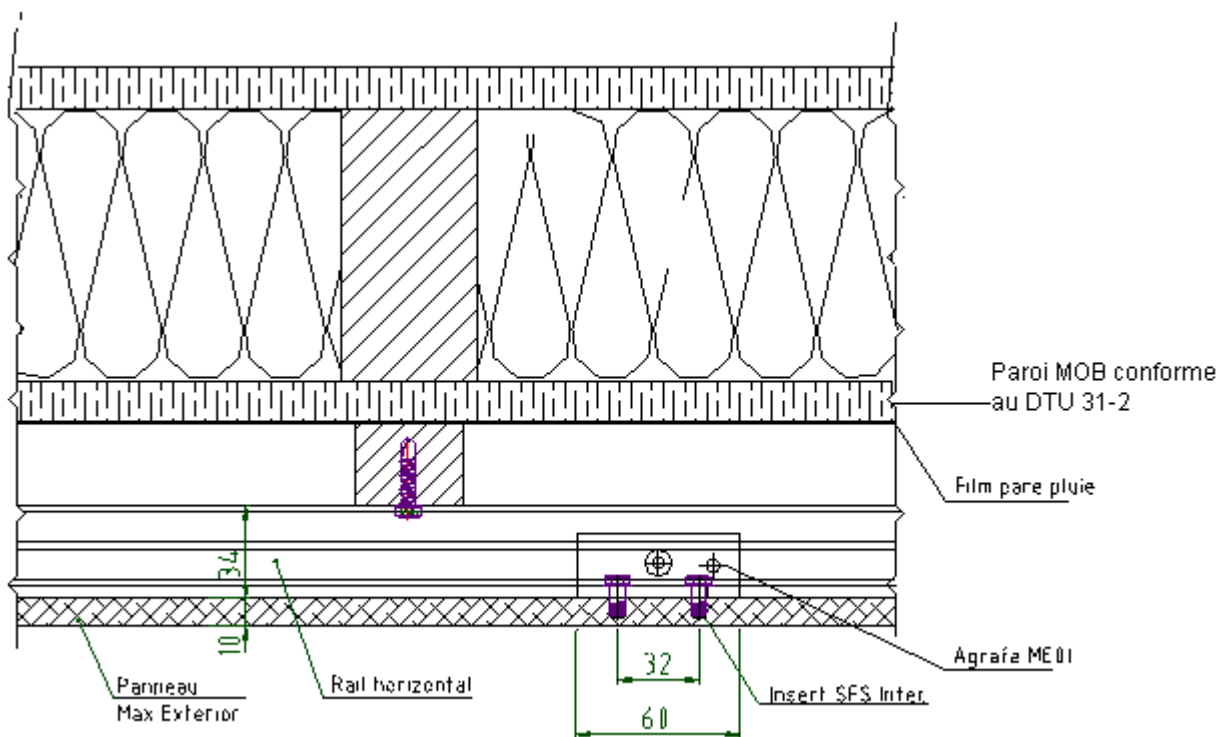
is – Coupe horizontale – Pose sur MOB- Détail fixation du rail sur tasseaux
